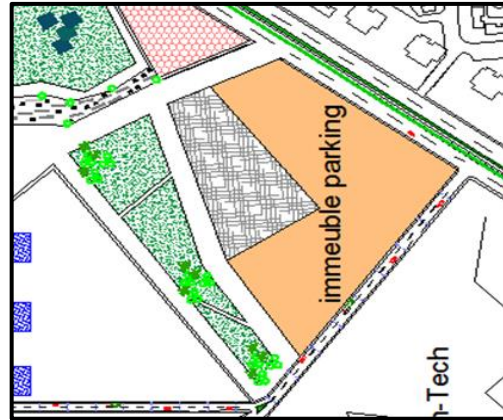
Vue en plan d'un parking a étage après l'intervention
